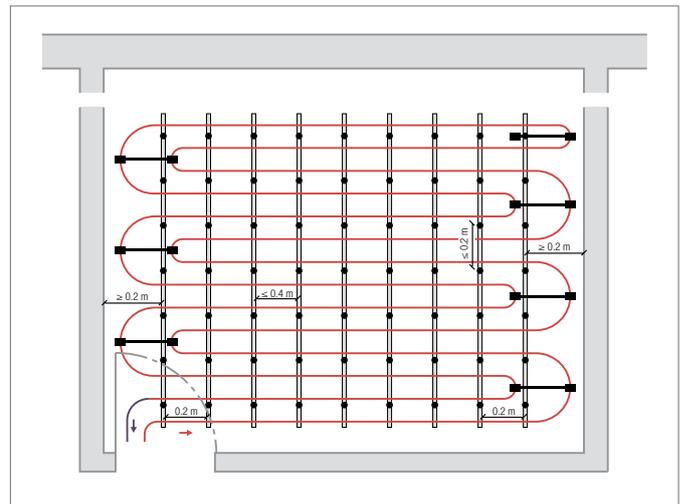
Version à double méandre, VA 5 cm (vue de dessus de la surface du sol)
